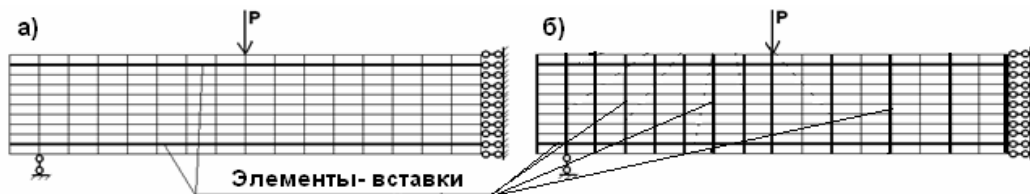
Расчетная схема балок: а) без поперечного армирования; б) с поперечным армированием
